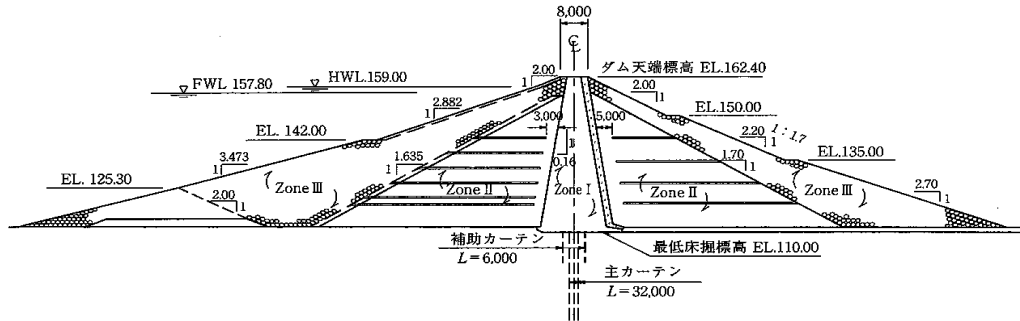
中心遮水ゾーン型フィルダムの事例（浪岡ダム）
